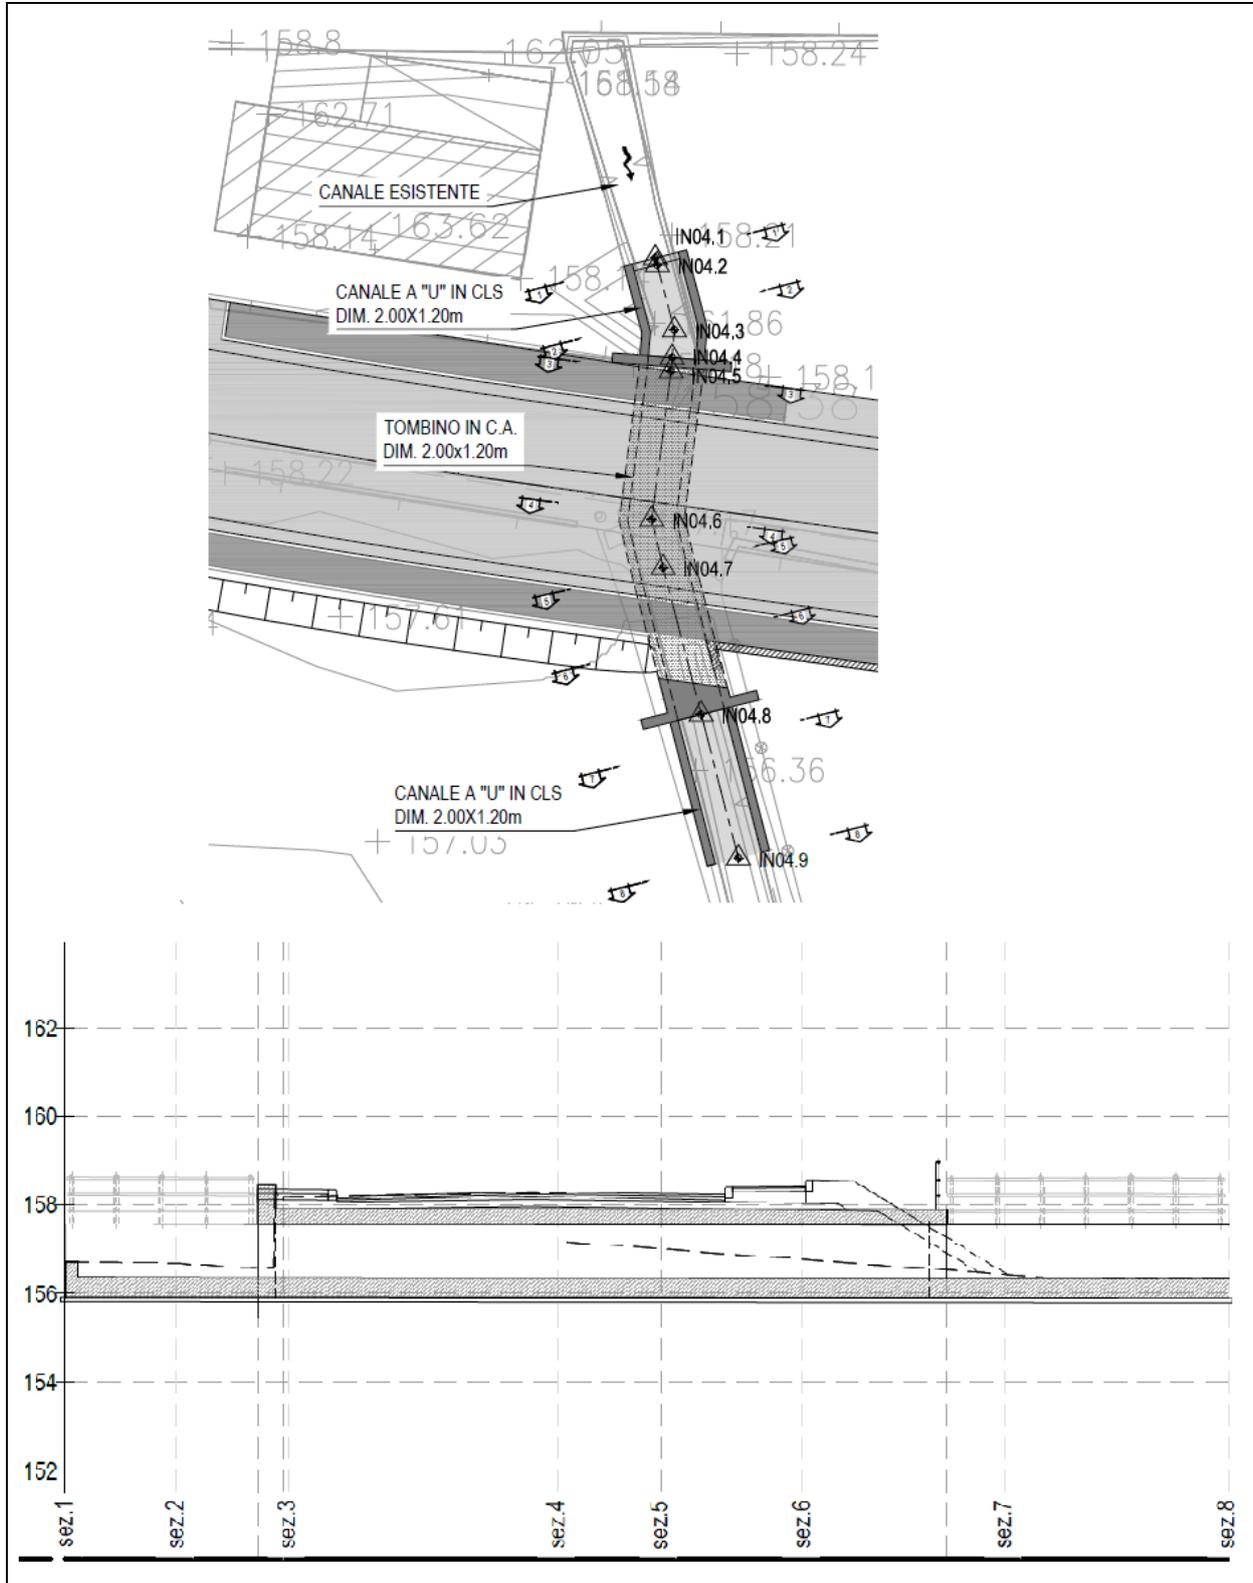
Inalveazione IN04 – Pianta e sezione longitudinale
